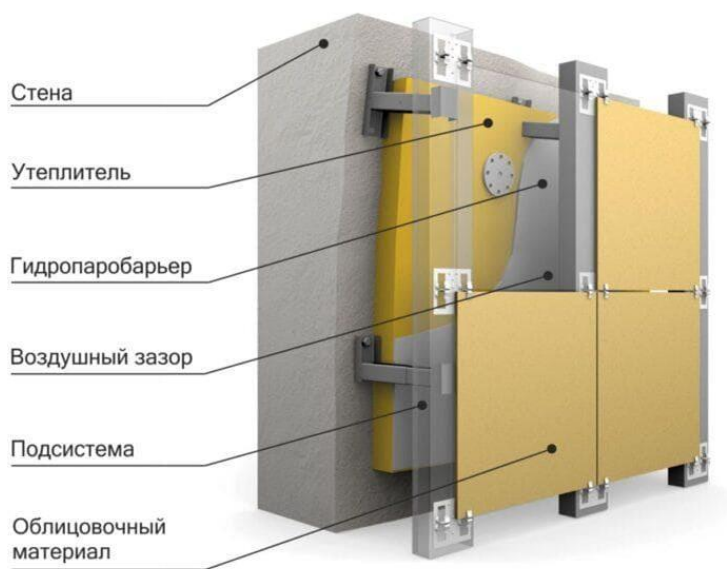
Конструкция системы утепления вентилируемый фасад
